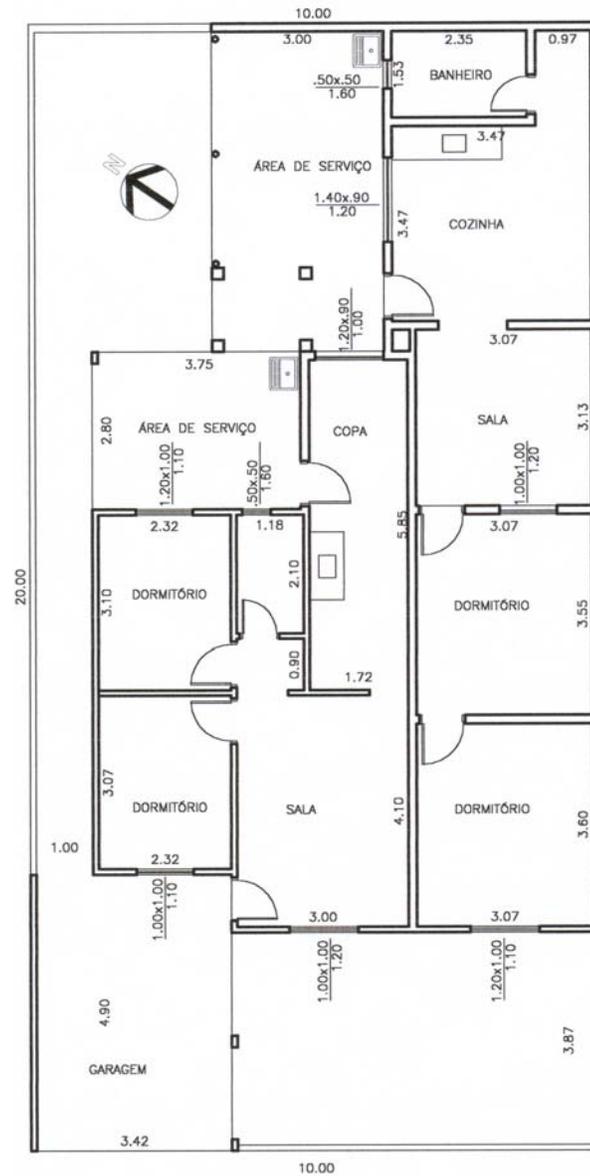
Loteamento Jardim Morro Azul Q1 lote 10
